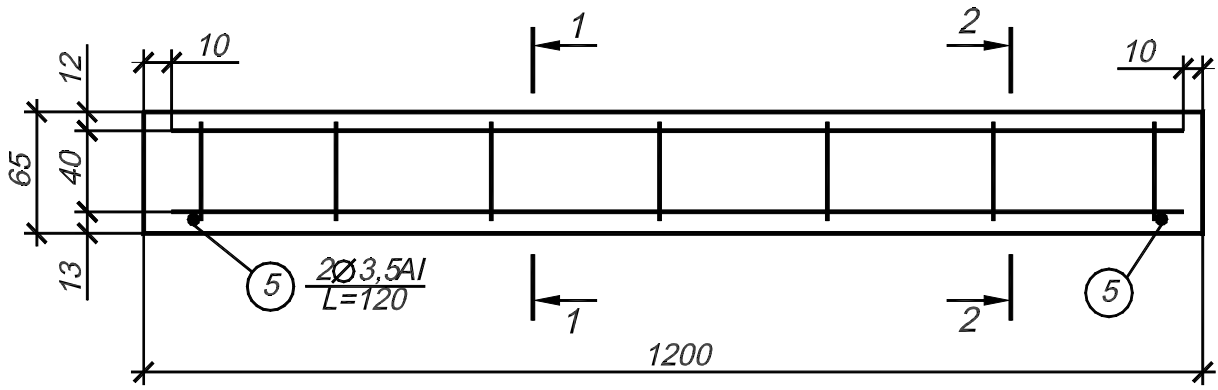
Варианты 6, 7, 8, 9, 10 задания «Железобетонные конструкции». Плита фундаментная ПФ4-2-1
